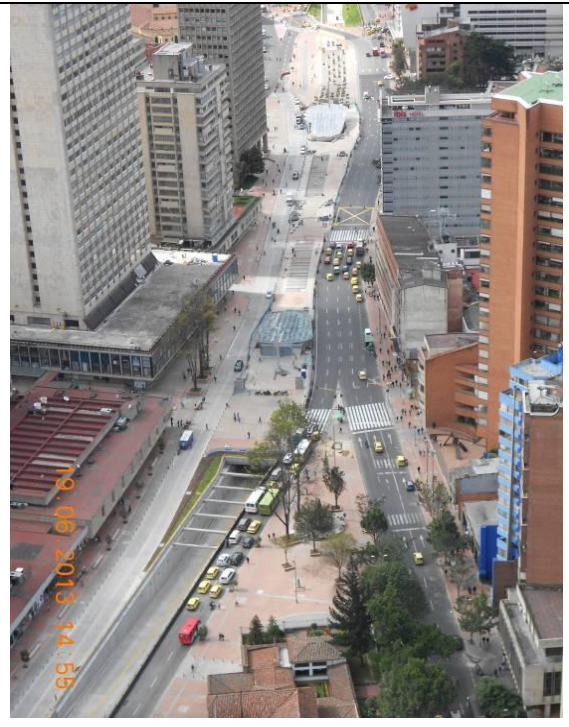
Carreras 10 y 7 entre Calles 26 y 32: Estado final obras Estación Museo Nacional y Pavimentos.
